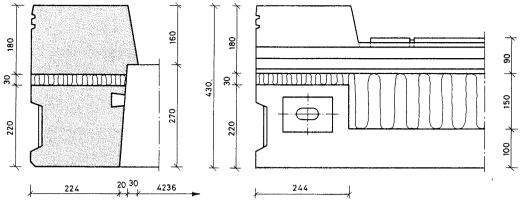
Detalje af facadeelement: Vandret snit og planbillede af endekant. Mål 1:10. Dobbeltsøjlen i facaden (se figur 5) er i virkeligheden en fortykkelse af forpladen uden tegl. Det bemærkes, at elementet er uden kuldebro. Den indvendige del af elementet er forsynet med plastklodser til montage af vinduer.
